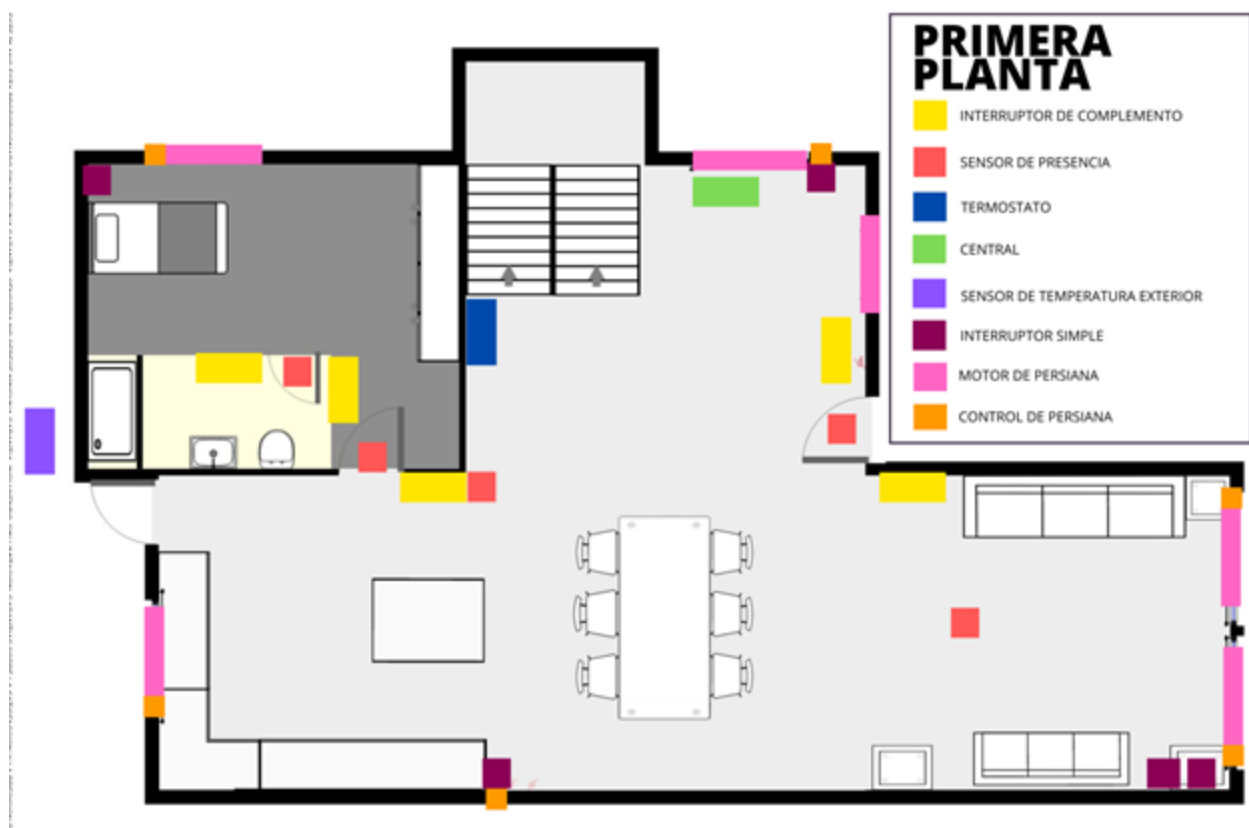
Distribución espacial de los componentes del sistema domótico, primera planta.
